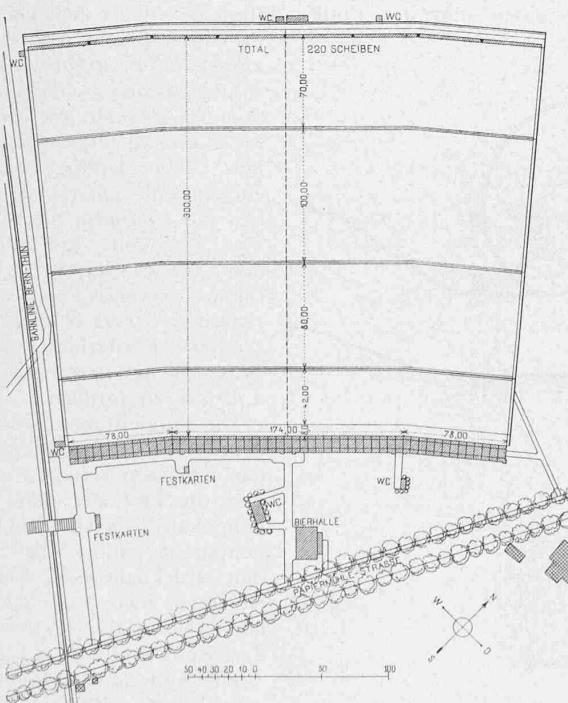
Lageplan der Schiessanlagen. — Masstab 1:5000.
